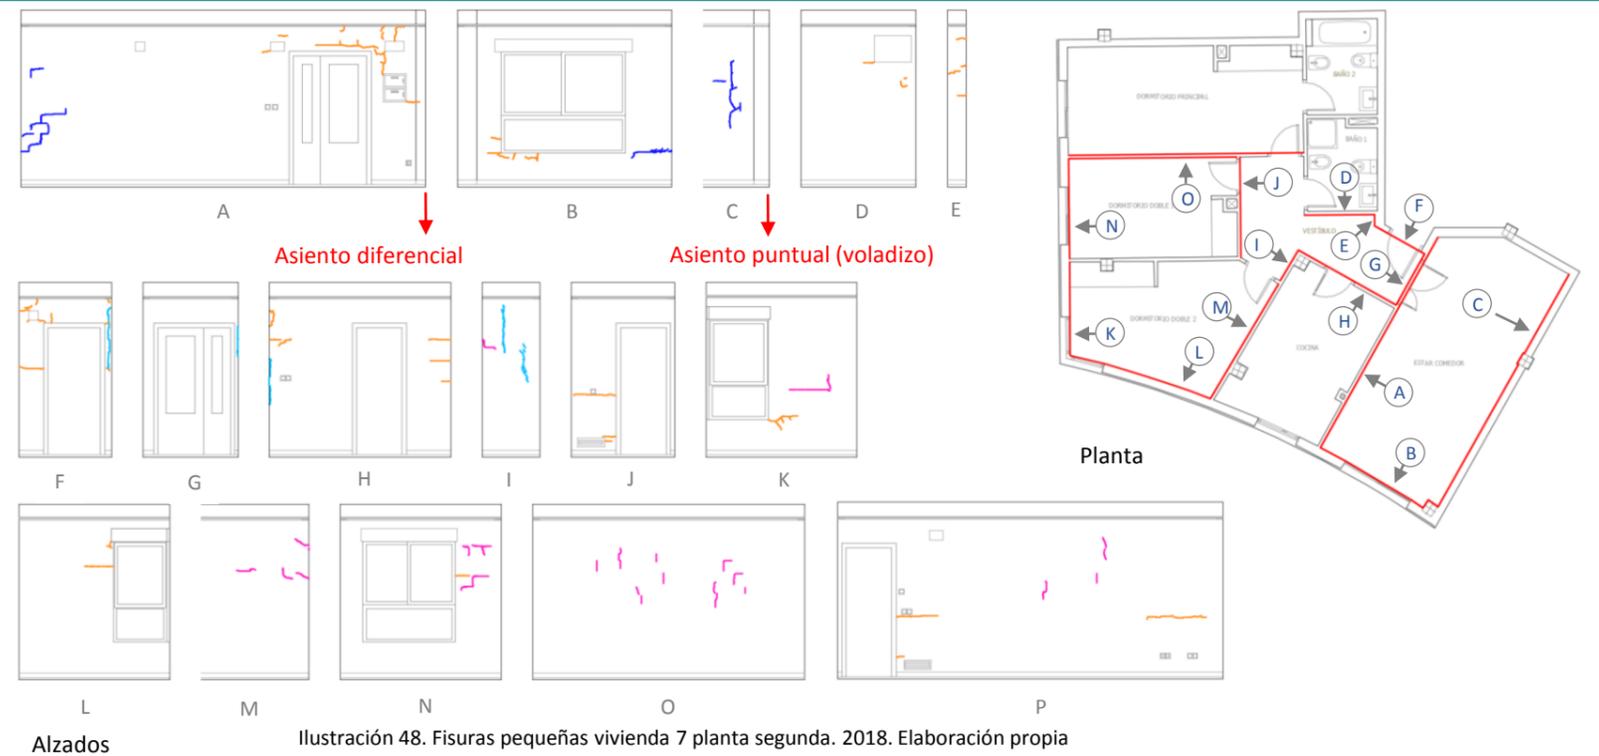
Fisuras pequeñas vivienda 7 planta segunda. 2018. Elaboración propia
